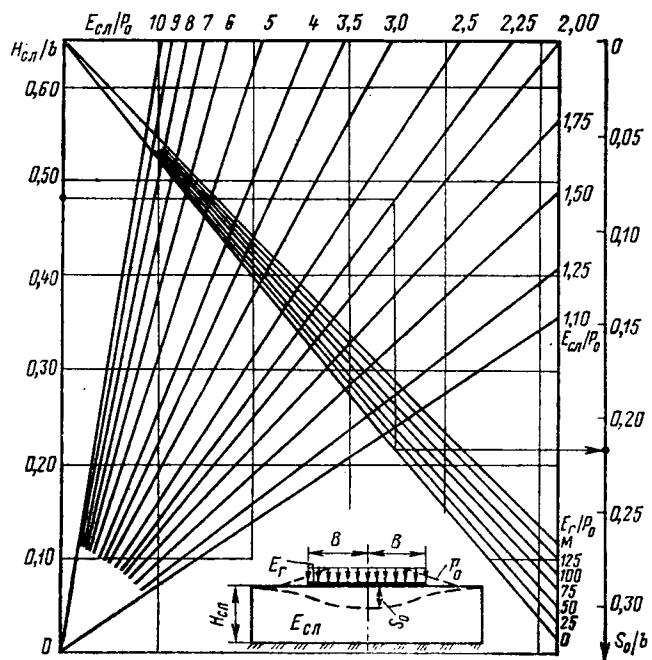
Номограмма для определения конечной осадки S_0 по оси насыпи на слабом основании с учетом влияния ее армирования геотекстильными материалами:
